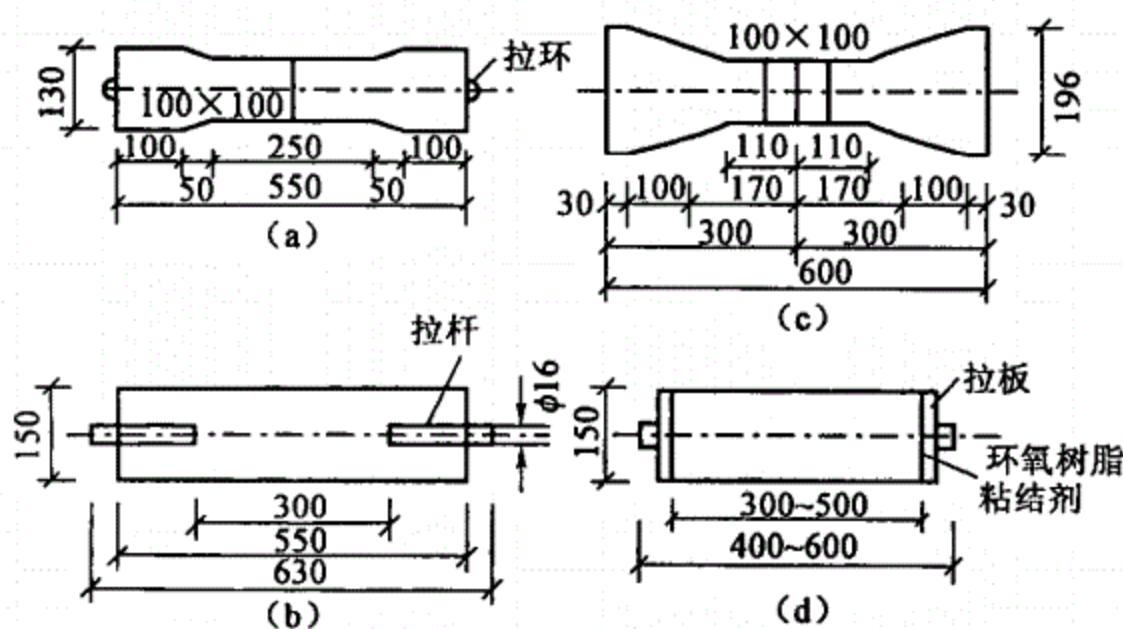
纤维混凝土轴向拉伸试件及埋件(单位:mm)
